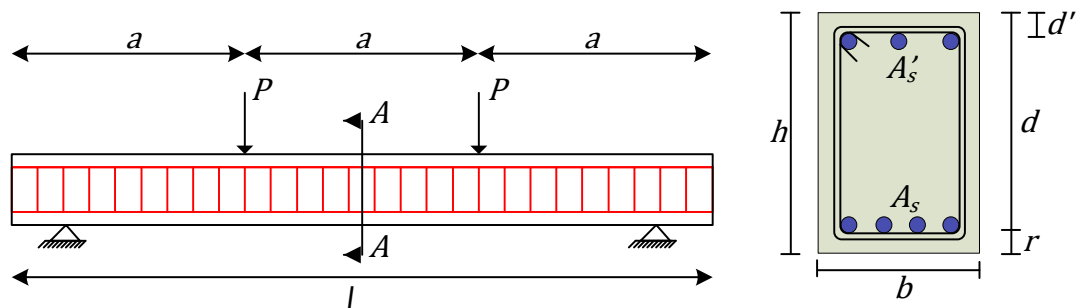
Viga de H°A° simplemente apoyada y su sección transversal A-A
